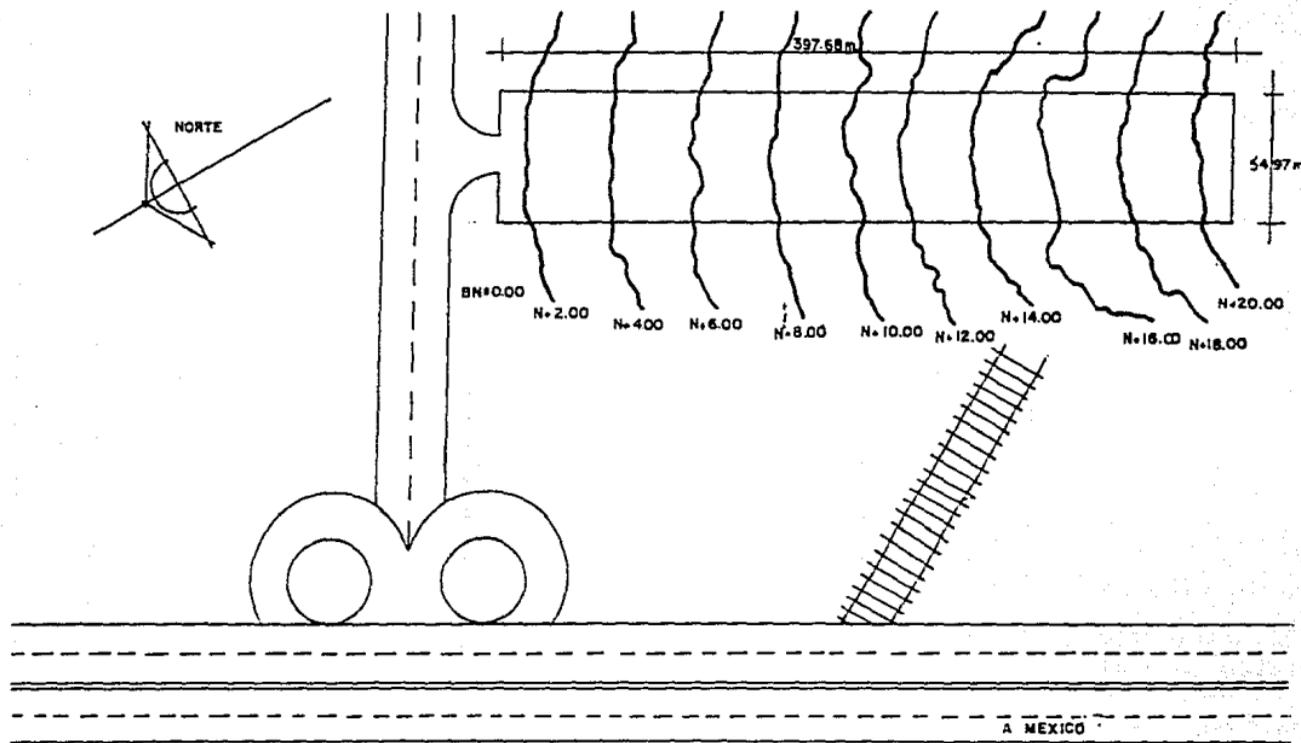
LOCALIZACION Y LEVANTAMIENTO DE LA PLANTA PROCESADORA
